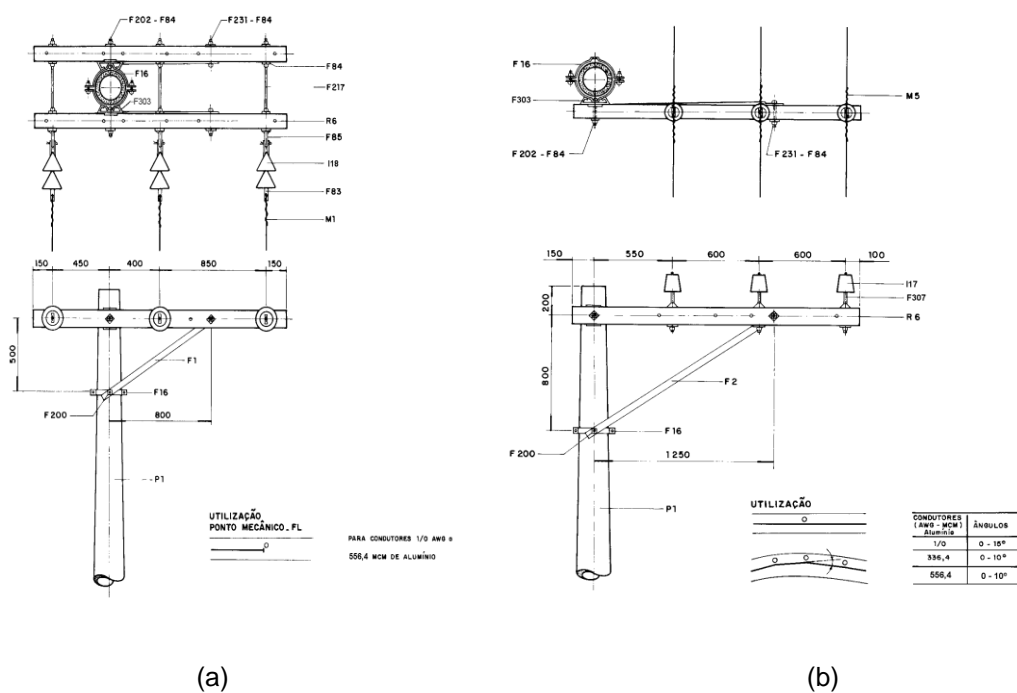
Estrutura básica classe 15 kV: a) Estrutura M3; b) Estrutura B1.
